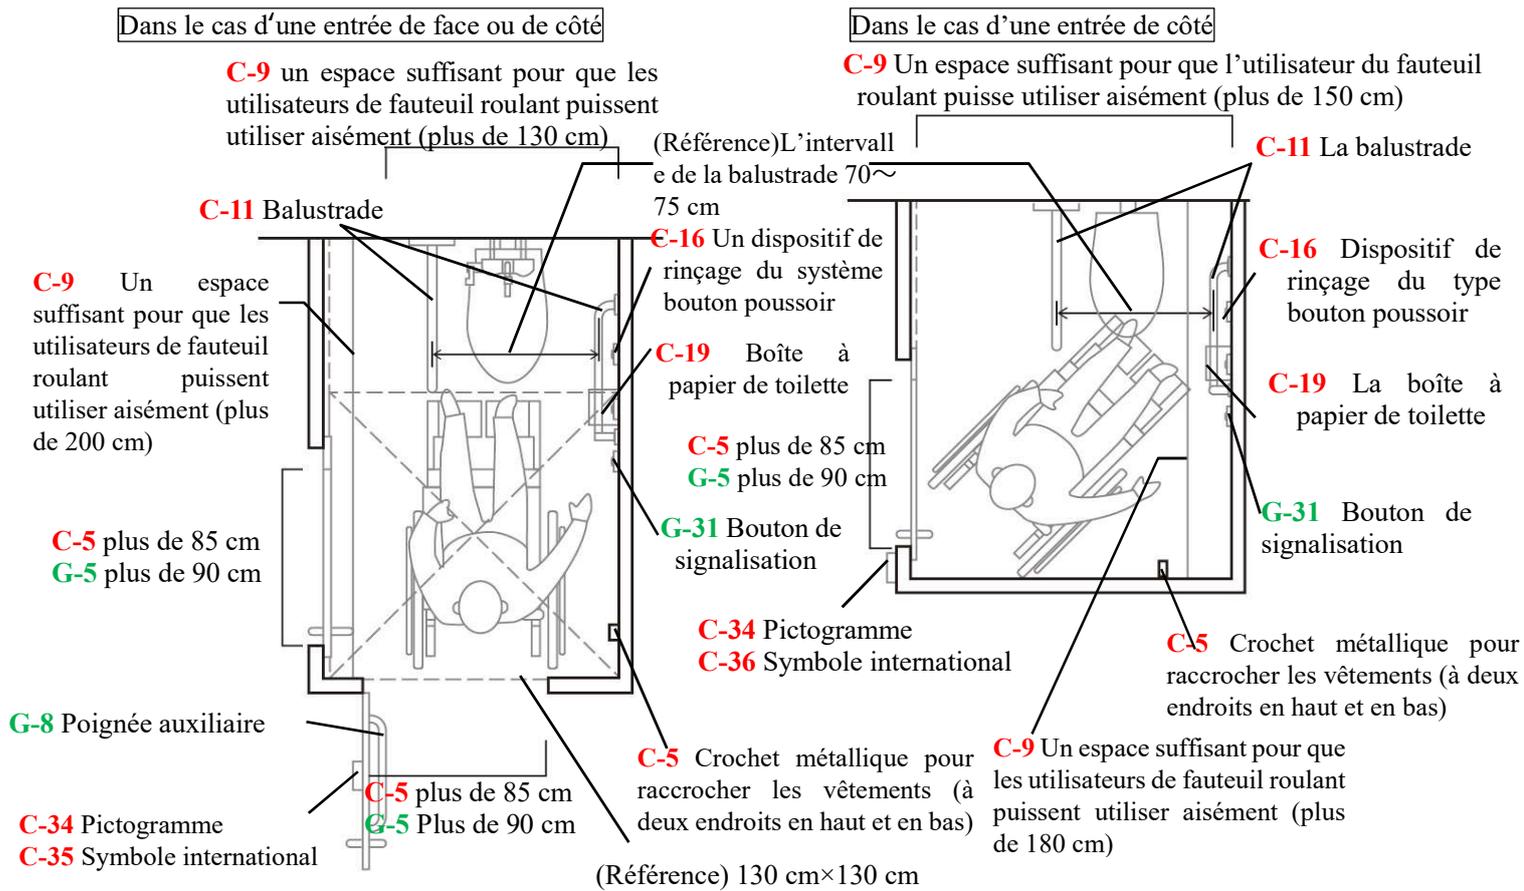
Exemple du plan de toilette de type simple pour les utilisateurs de fauteuil roulant
